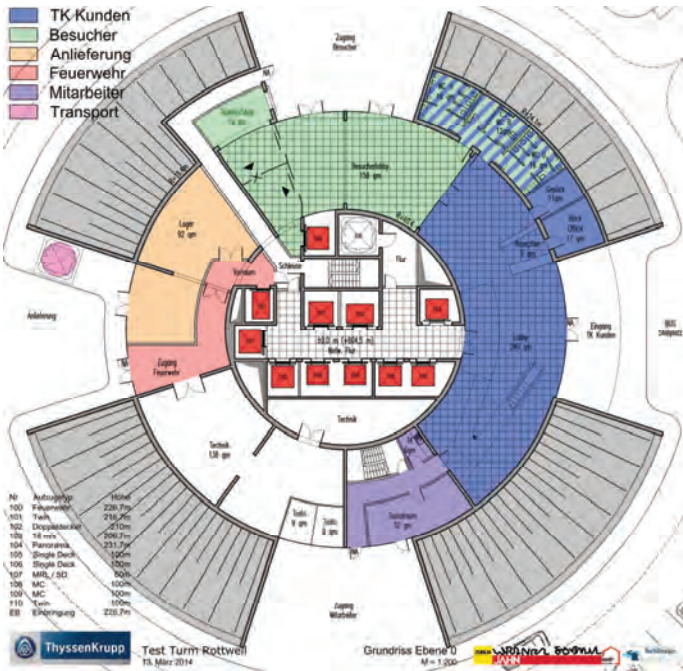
Grundriss EG mit Darstellung der Flächenaufteilung
